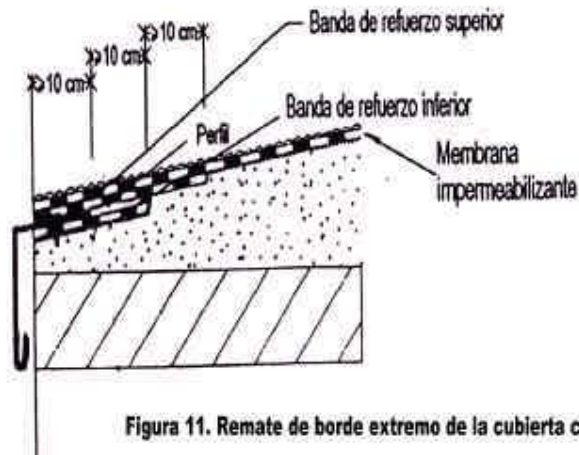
Remate de borde extremo de la cubierta con perfil metálico
